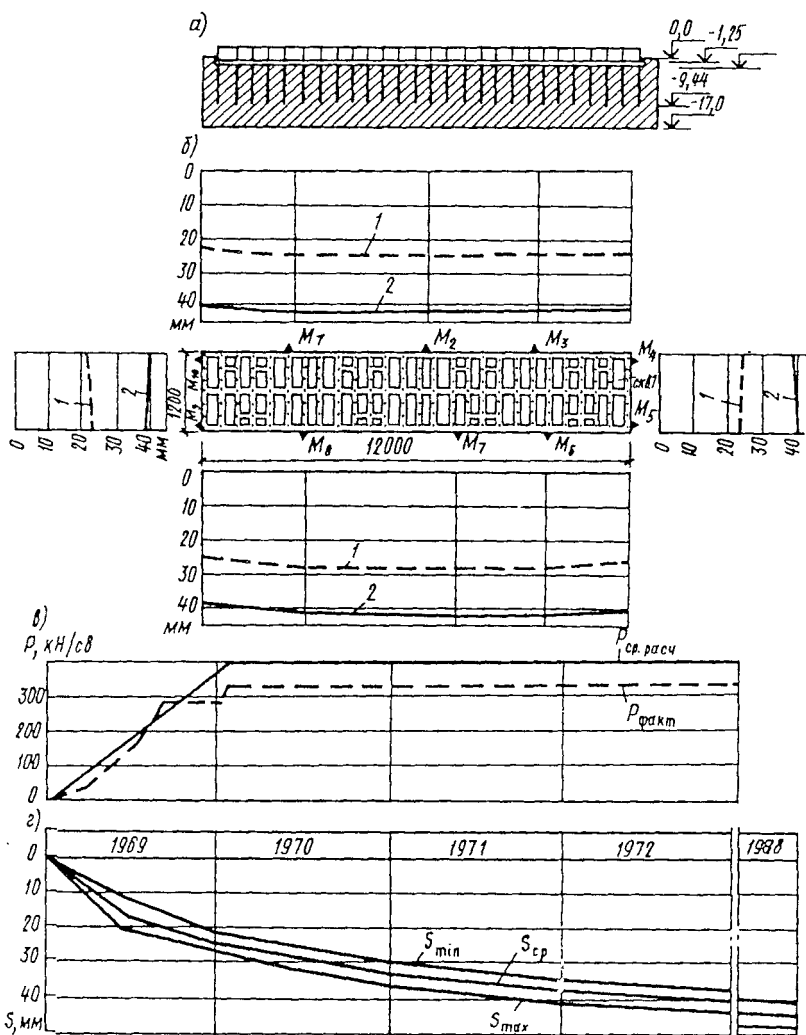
Результаты исследования дома № 32 по ул.Центральной (свайный фундамент запроектирован по предельно допустимым осадкам)
